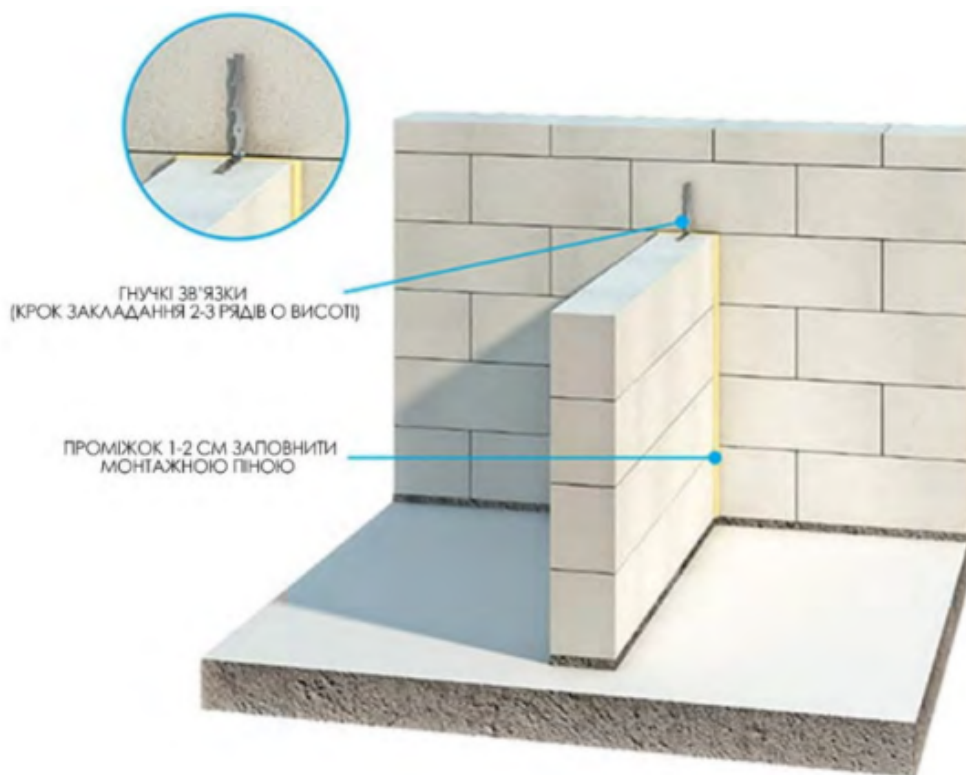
Кріплення перегородки до зовнішньої стіни
